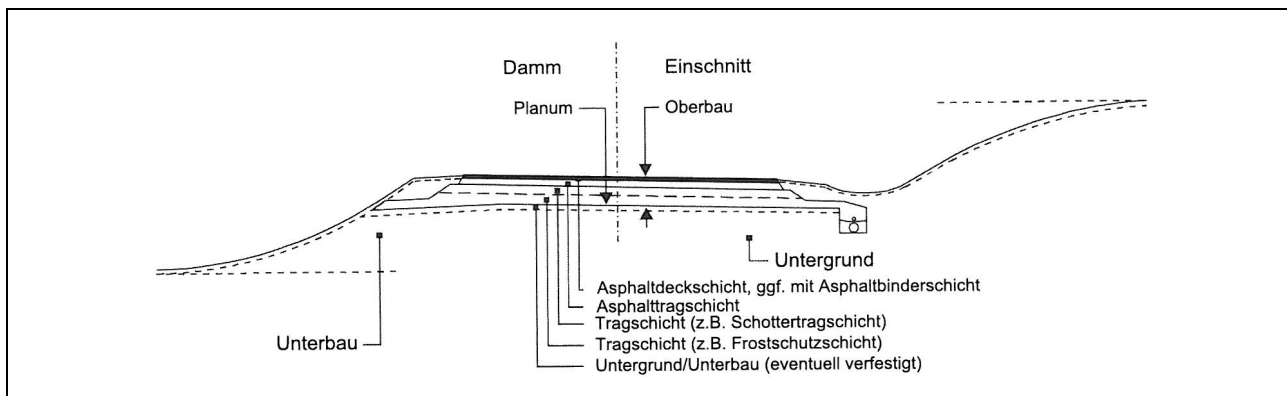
Aufbau einer Straßenbefestigung in Asphaltbauweise außerhalb geschlossener Ortslage mit wasserdurchlässigem Randbereich [ZTV Asphalt-StB 07]
